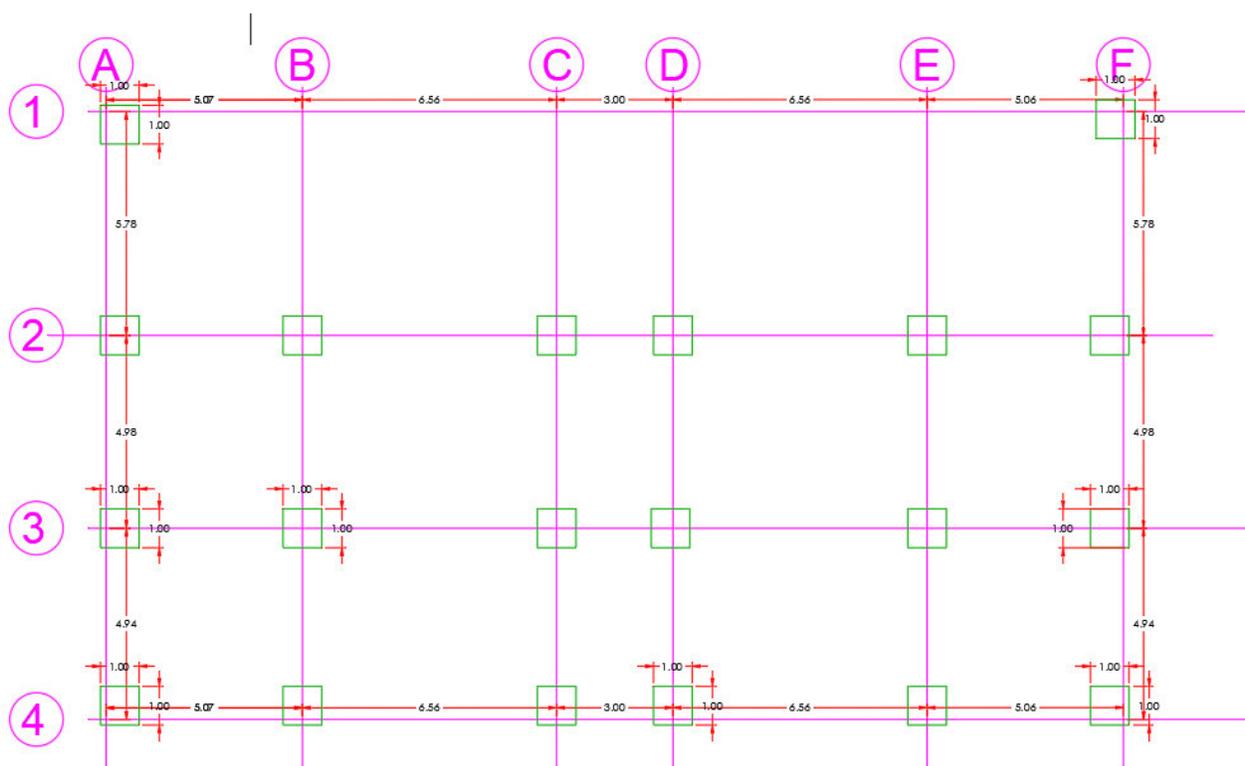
Vista en planta piso tipo, dimensiones y muros.
